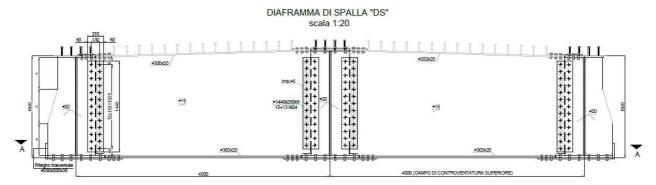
Sezione trasversale su diaframmi di spalla
